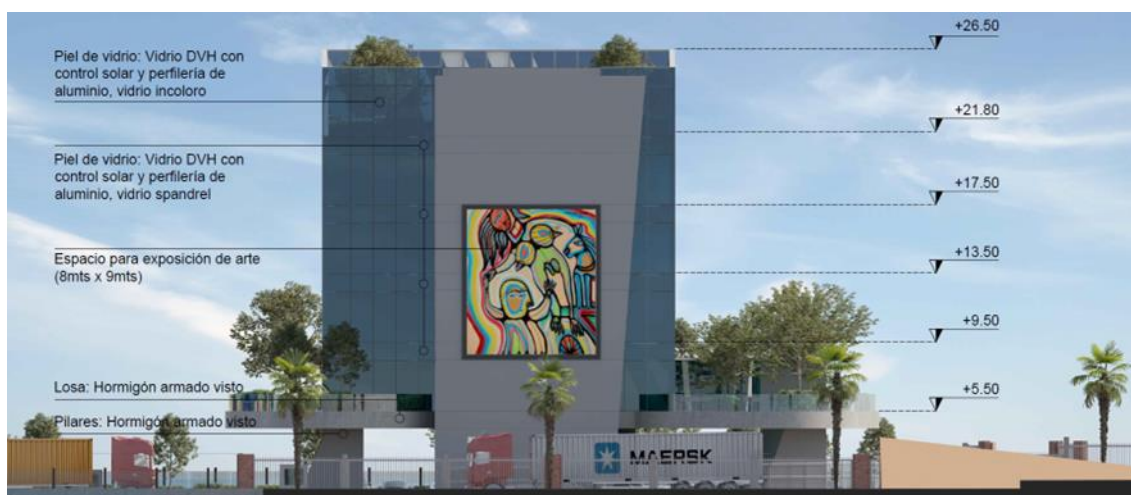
Esquema de alzado de la fachada Sur del edificio.
